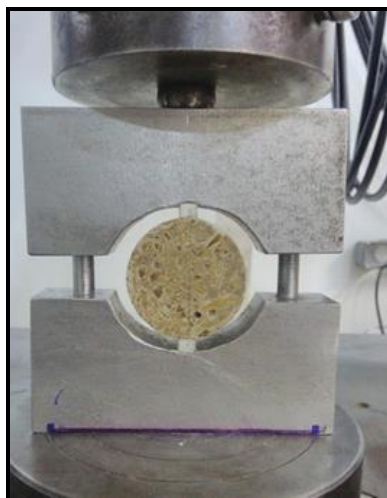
Ensaio de tração direta do bioconcreto de bambu.
